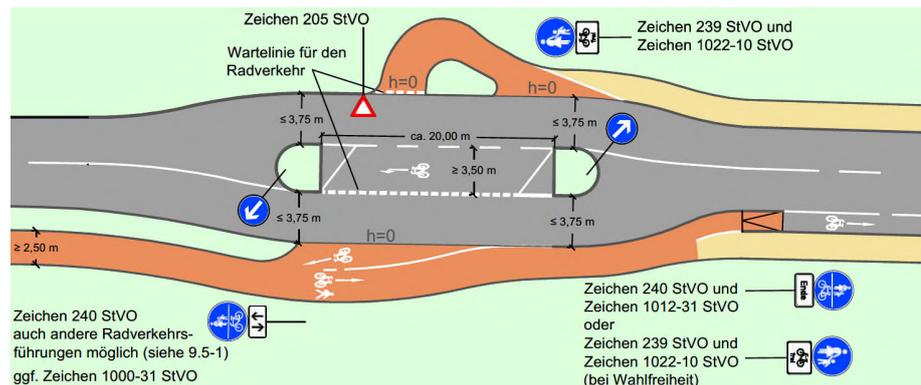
Muster für einen Wechsel der Führungsform mit Mittelinsel
